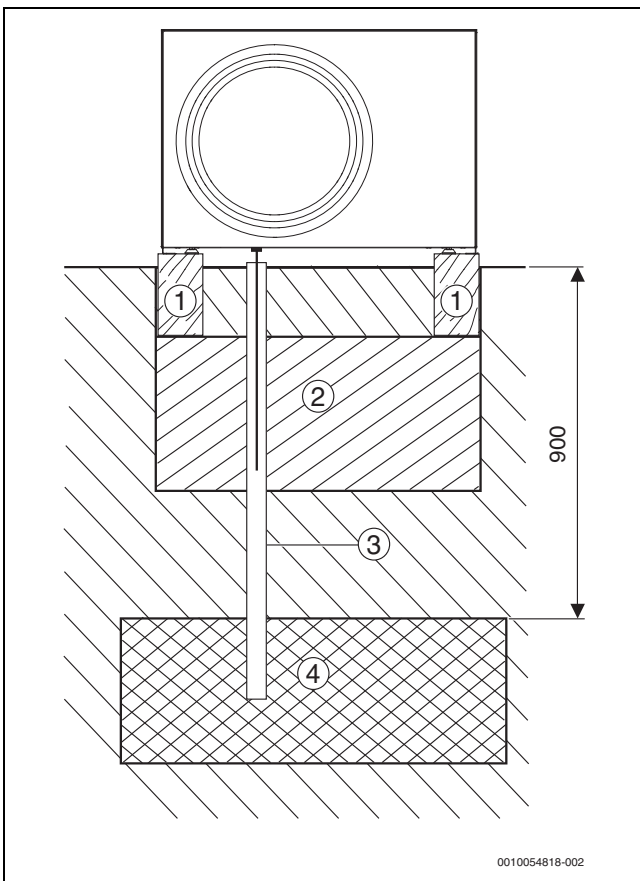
Kondensatableitung in Kiesbett (Abmessungen in mm)
